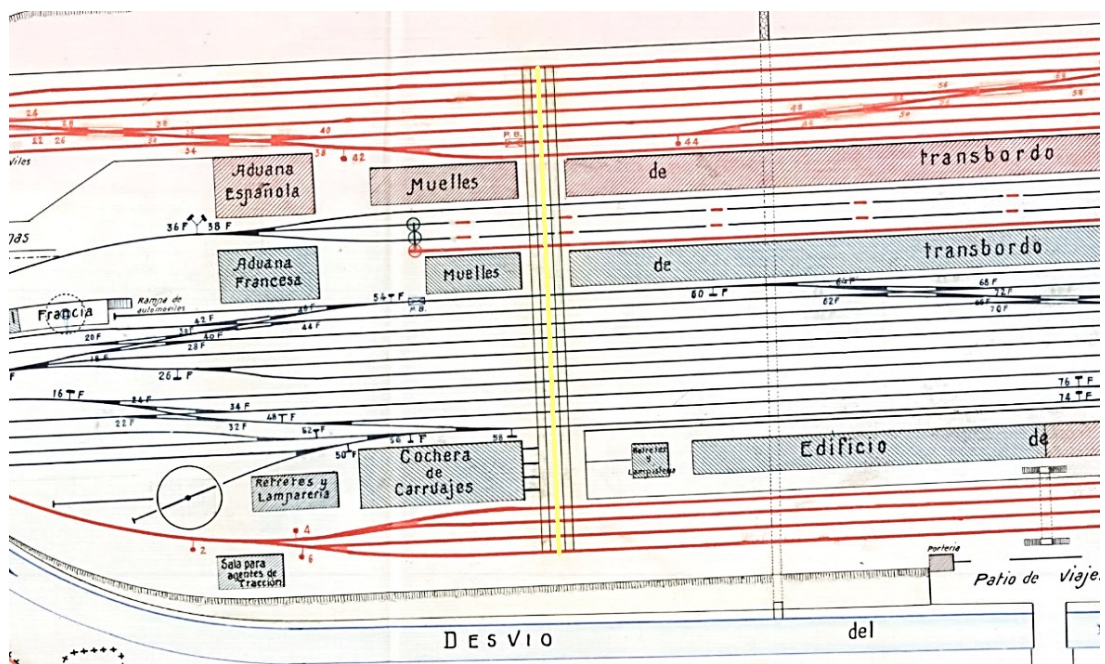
Diseño del trayecto transversal al sentido de las vías del carretón (en color amarillo), según un plano de la estación de 1917 elaborado por Ramírez de Dampierre.
